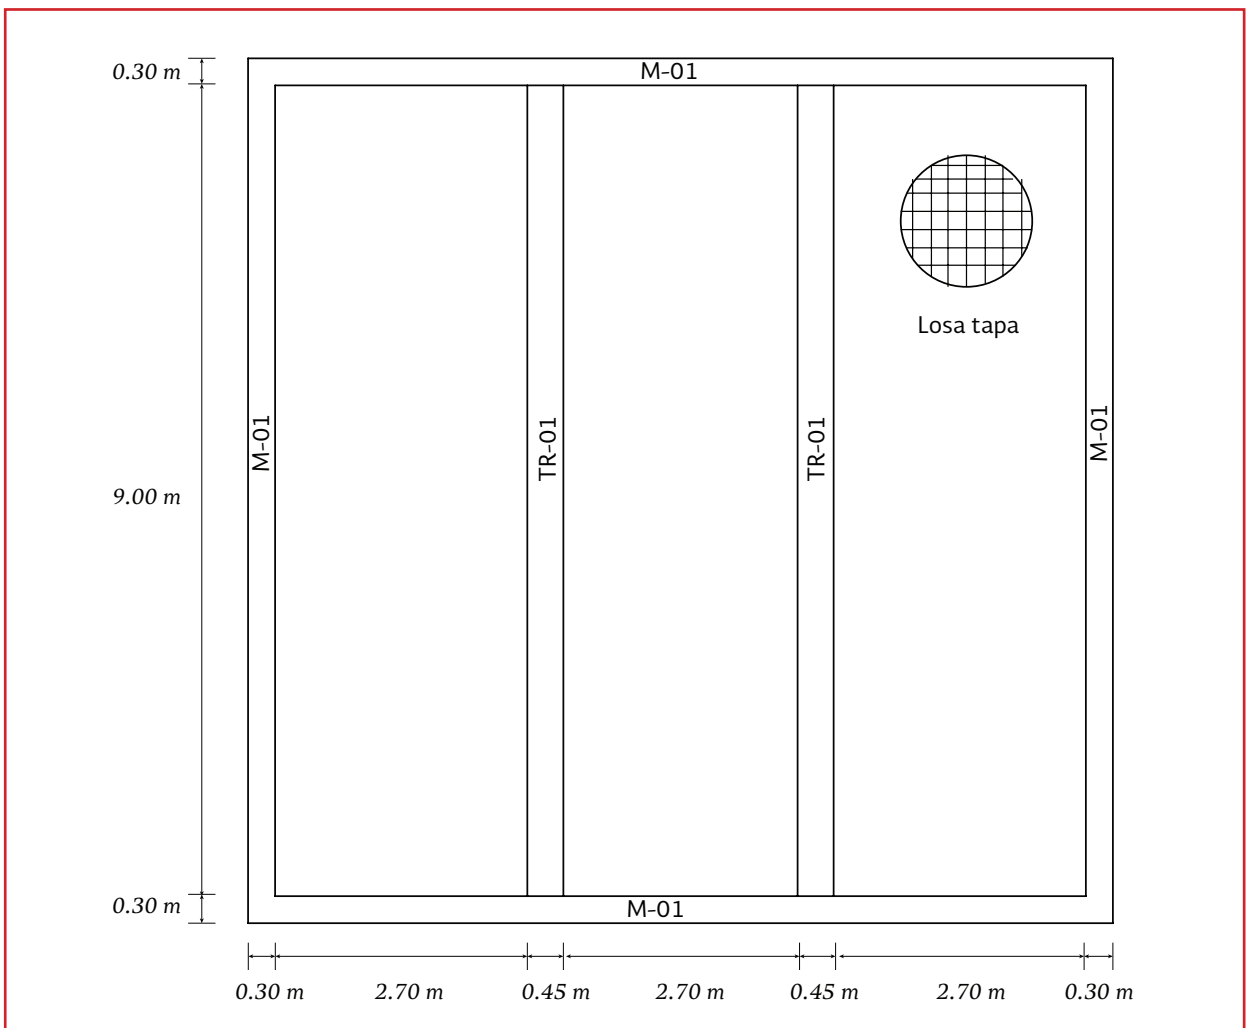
Elementos estructurales a considerar en el tanque semienterrado (vista en planta)
